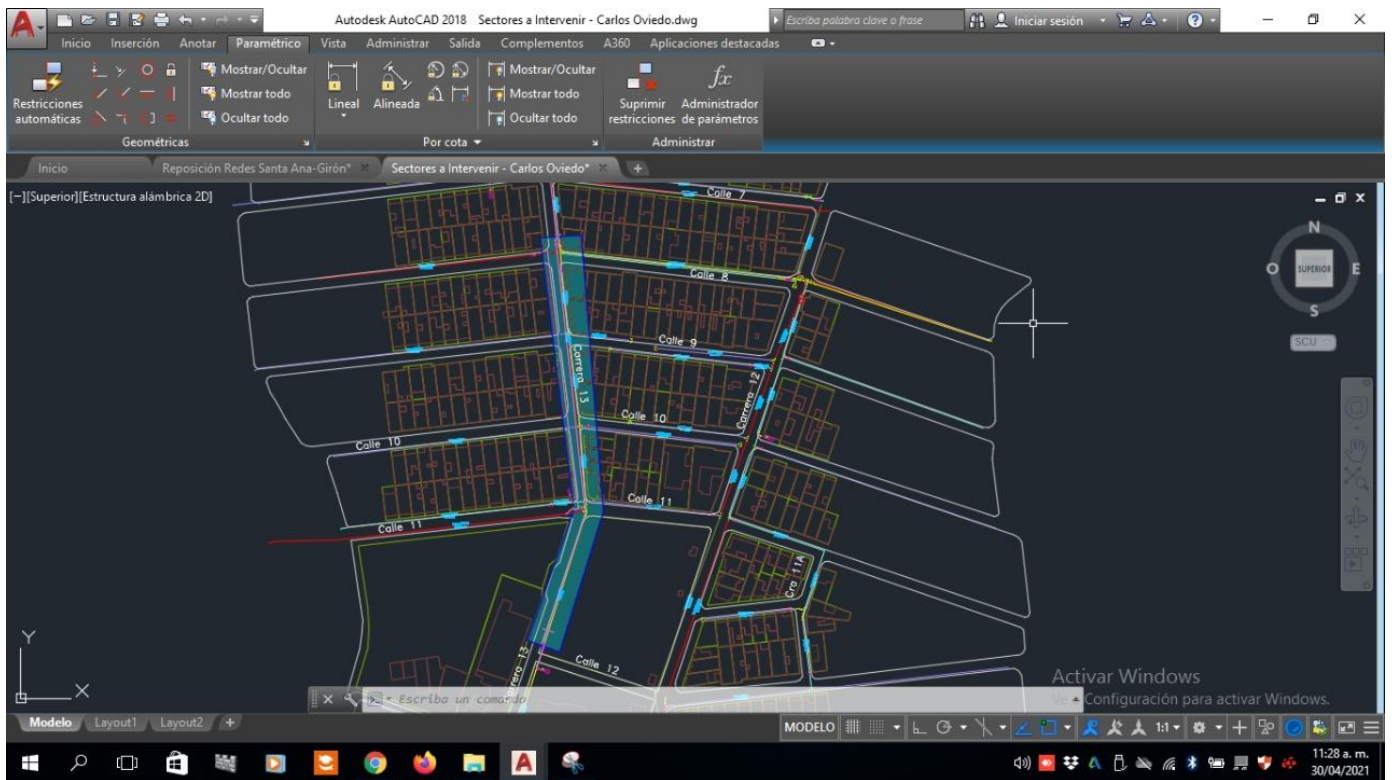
Plano de zona a intervenir en el barrio Villabel
